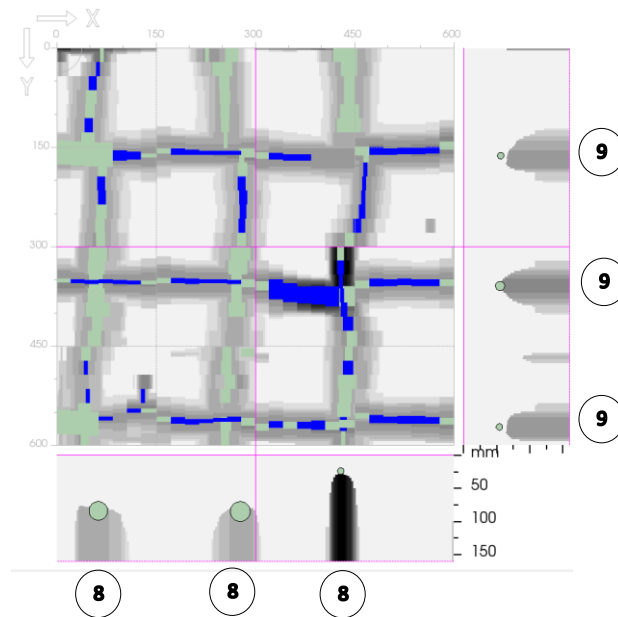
Ferrailage reconnu – Poutre Pt02
